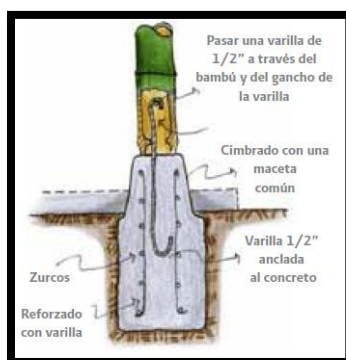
Anclaje en columnas con elementos verticales incl. pasador y refuerzo de acero
